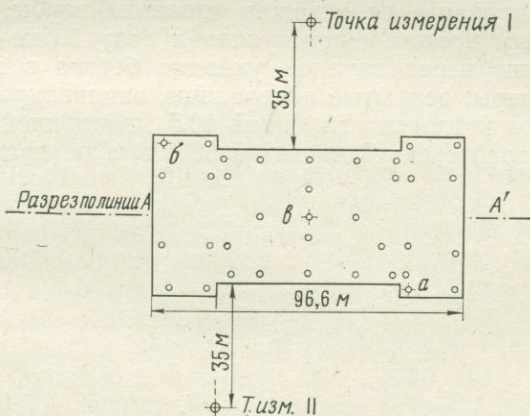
План-срез фундаментной плиты здания, показанного на рис. 5.42.
